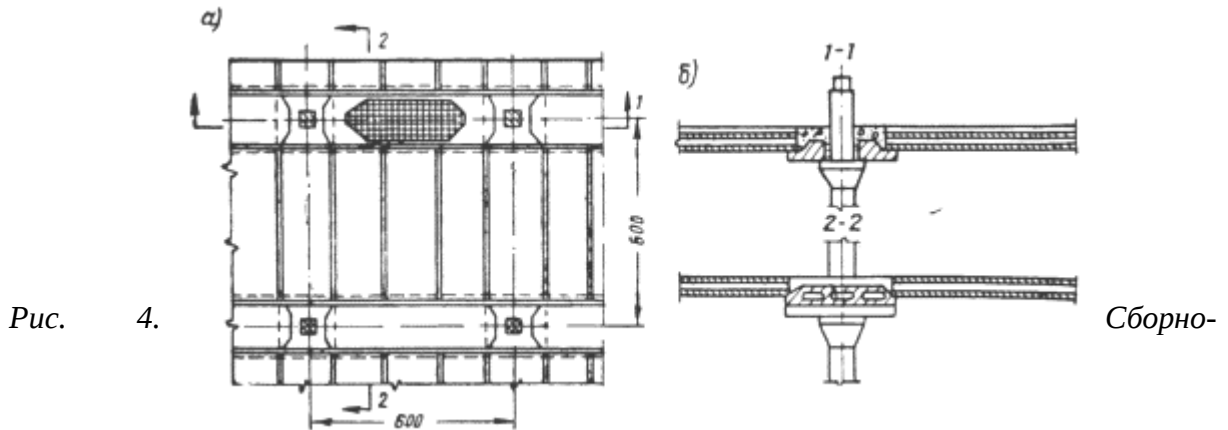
монолитное безбалочное перекрытие. а — план; б — разрез.
